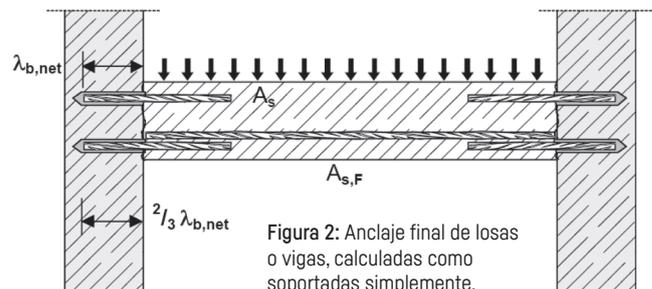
Anclaje final de losas o vigas, calculadas como soportadas simplemente.
